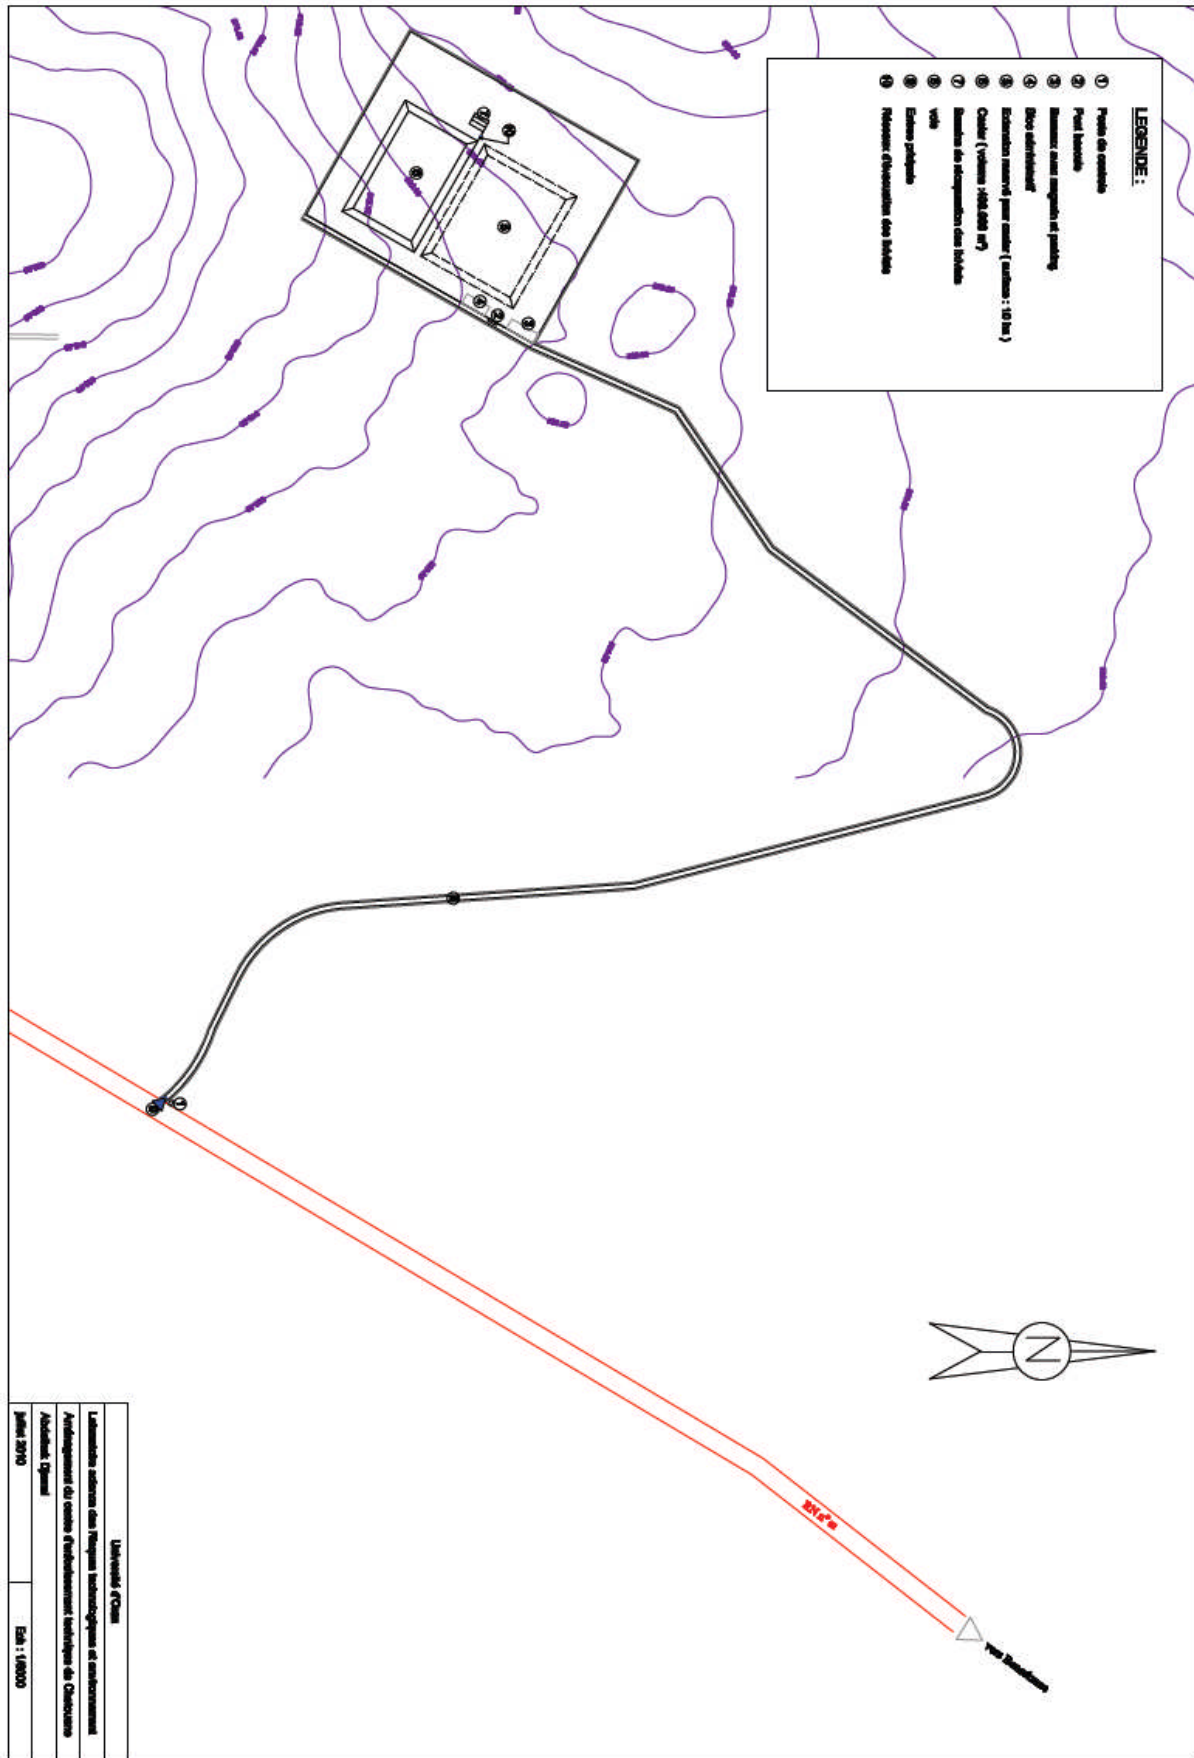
plan d'aménagement du centre d'enfouissement technique de Chetouane
